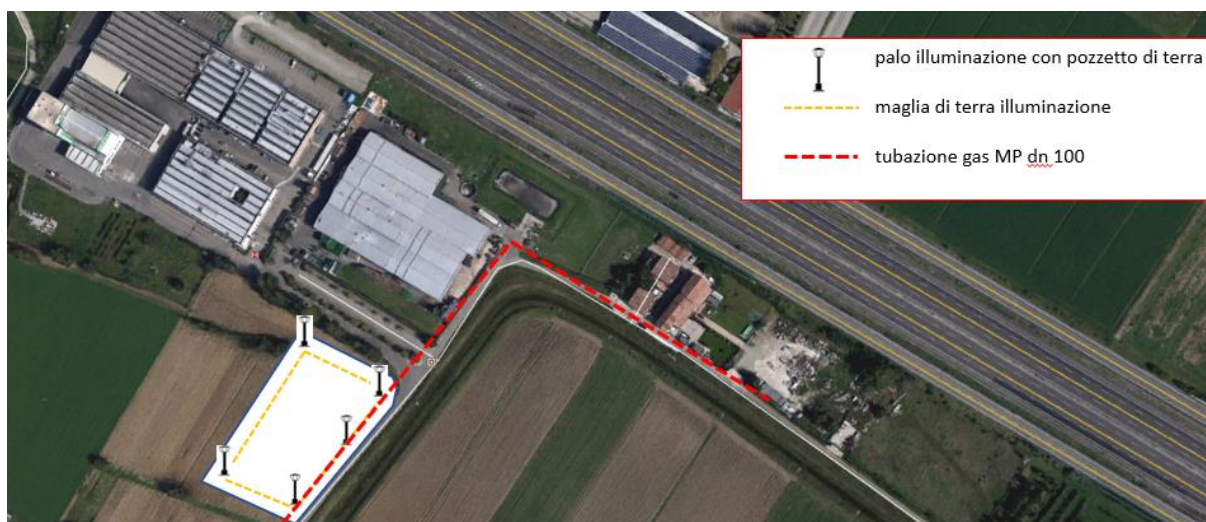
Planimetria rete gas da esaminare con dati di misurazione della corrente del segnale
